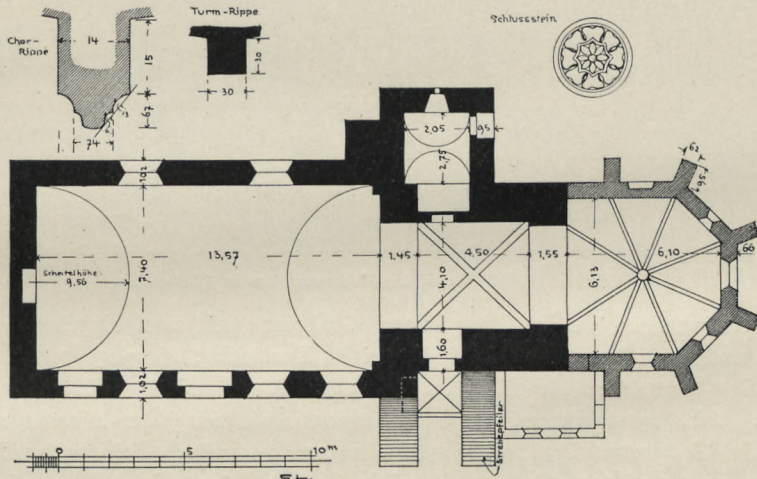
Alfeld. Grundriß und Details der Pfarrkirche.
